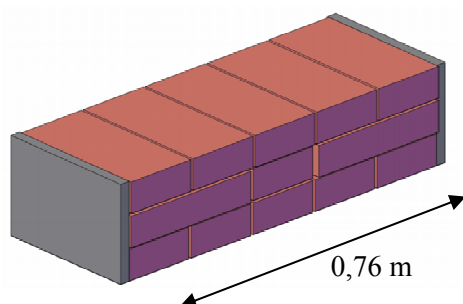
Planta baixa da Galeria de arte – Trecho de parede selecionado
